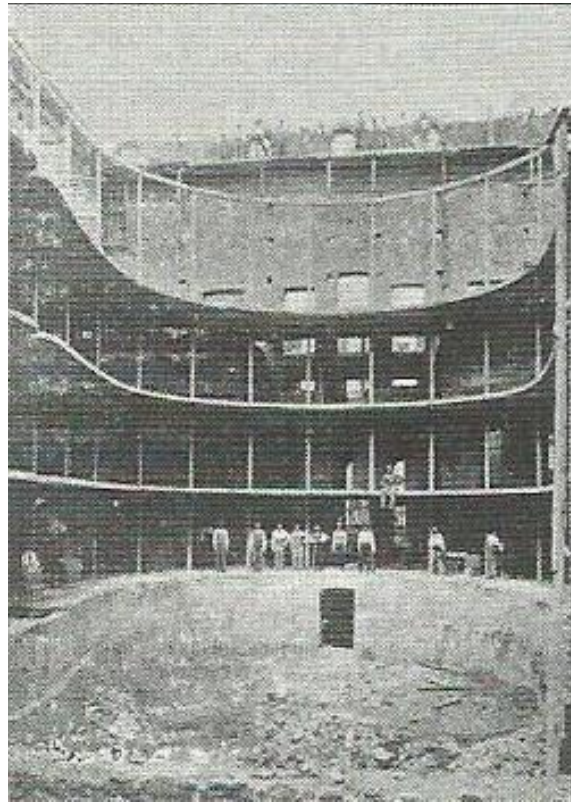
Obras en el Teatro de Avilés. Revista El Cemento Armado No.12 año 1901
